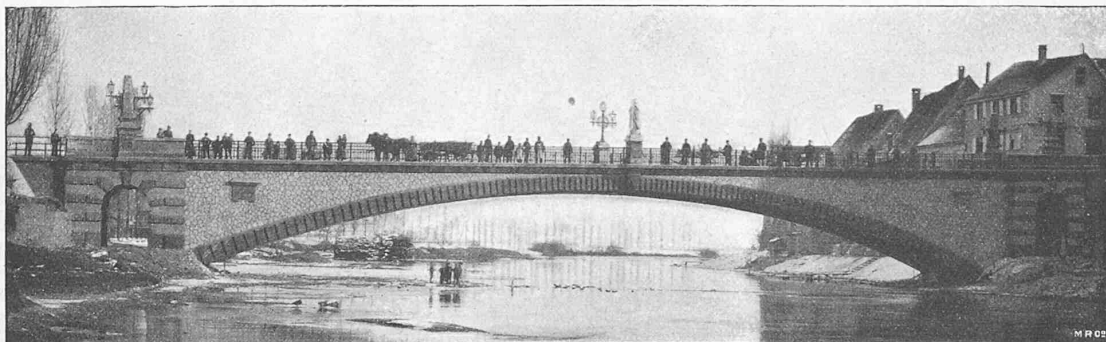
Stampfbeton-Brücke über die Donau bei Munderkingen.
